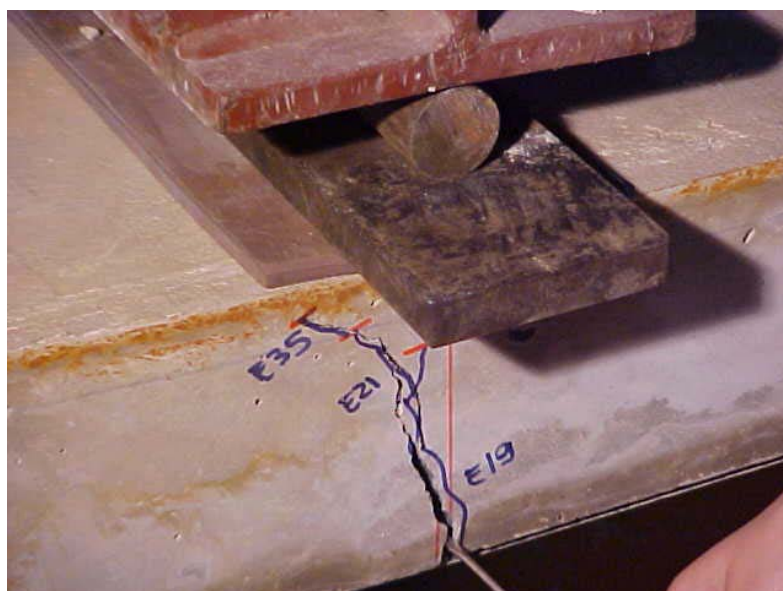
Detalhe da fissura sob uma das linhas de carga no colapso.
